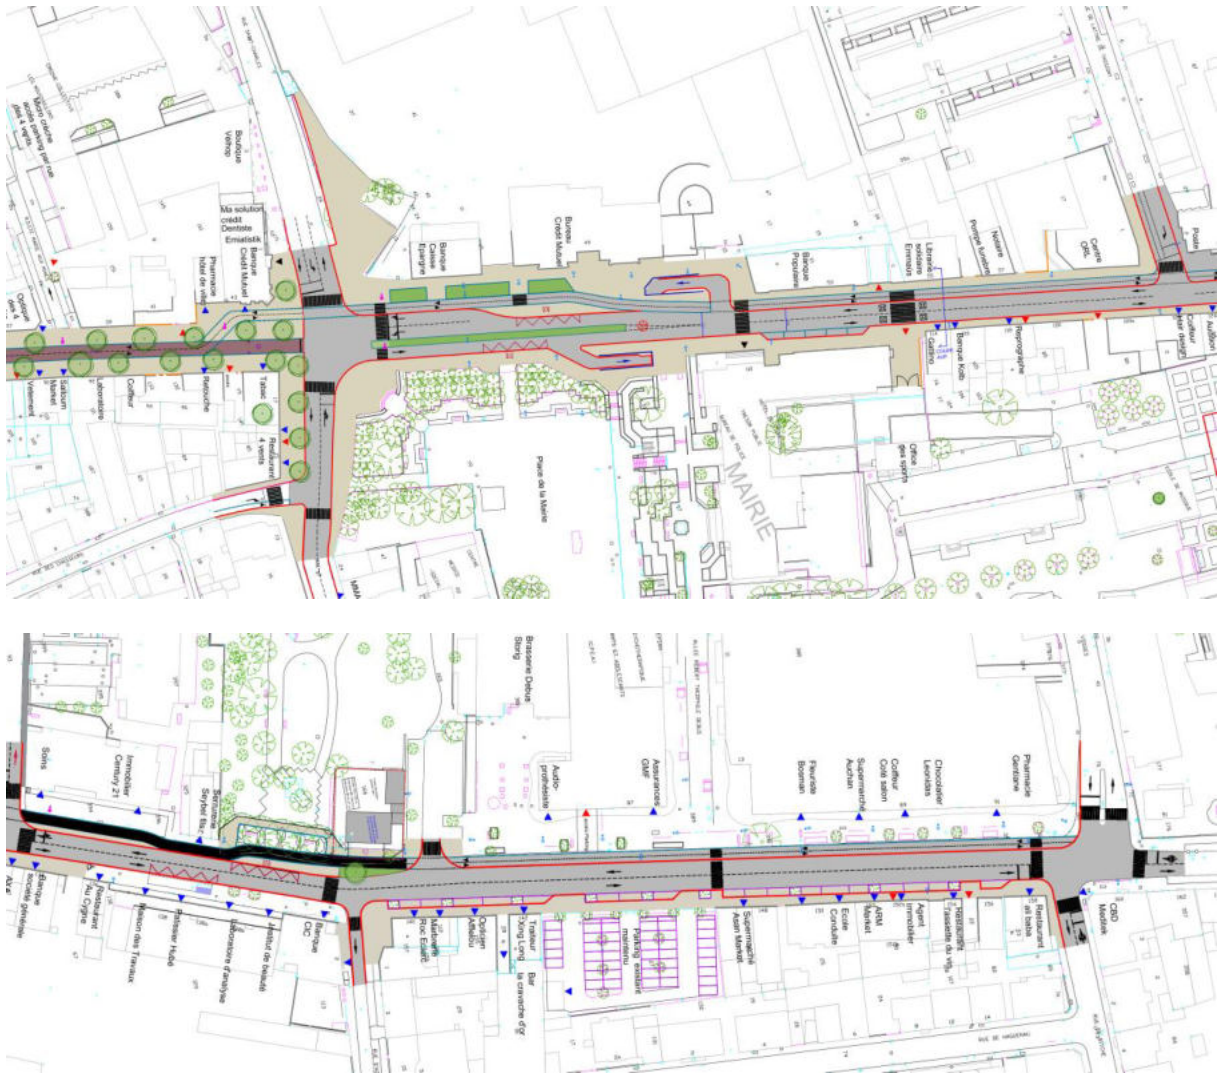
VUES EN PLAN DE LA ROUTE DE BISCHWILLER – SECTION ENTRE LA RUE SAINT CHARLES ET LA RUE DES VOSGES
